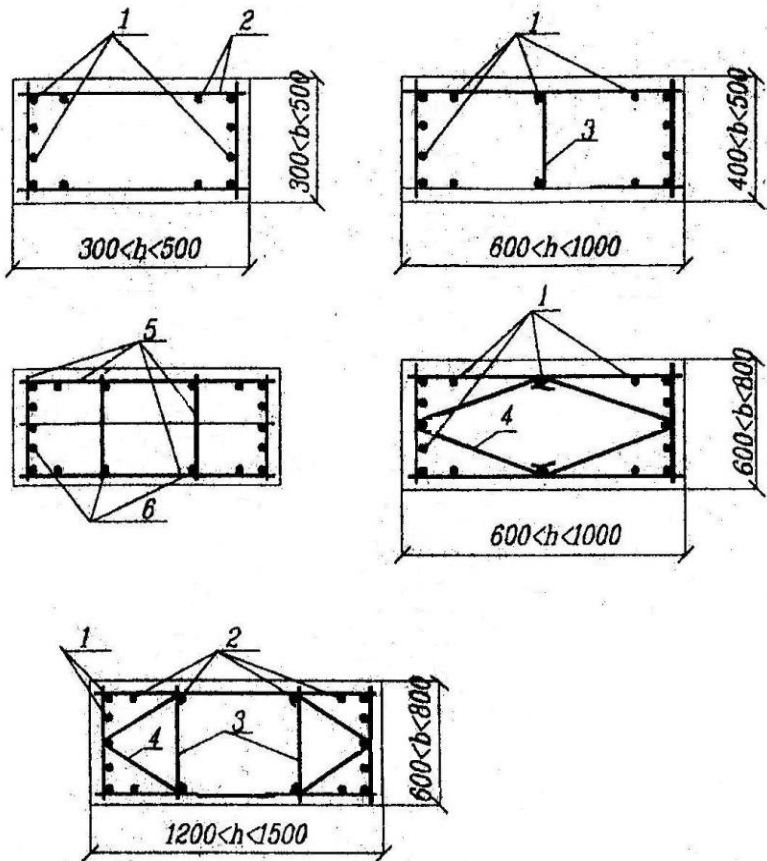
Примеры армирования сечений колонн с рекомендуемым количеством стержней плоских сварных каркасов:
